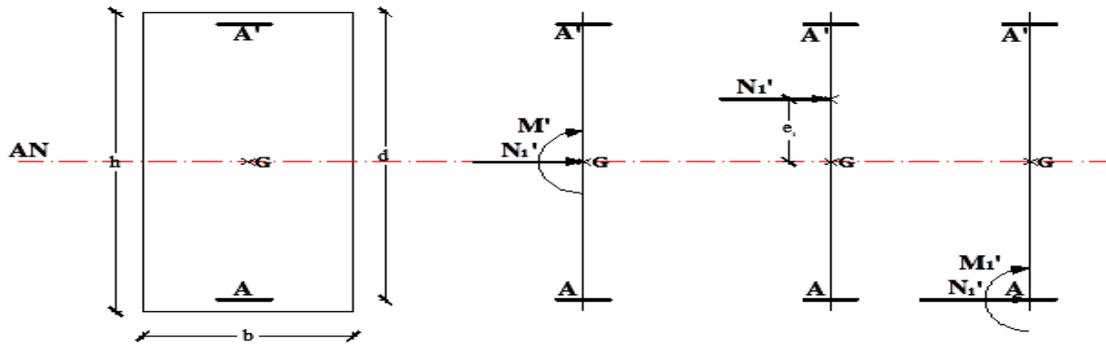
Position de N_1' , M_1' et M_1 sur la section transversale
